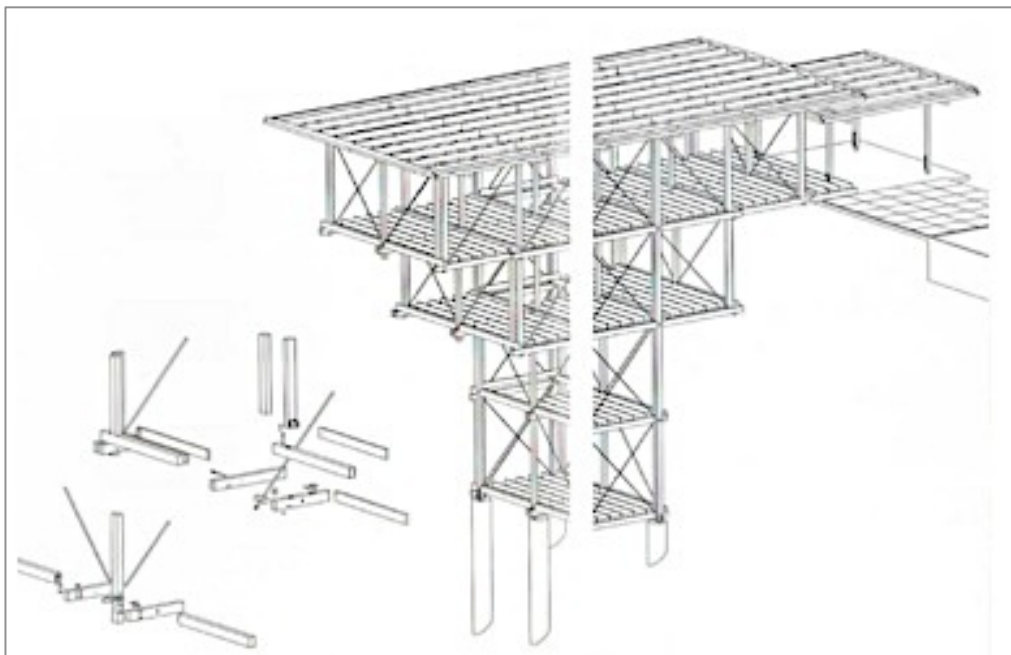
Estrutura das vigas pilares. Fonte: TOWFIQ L.
